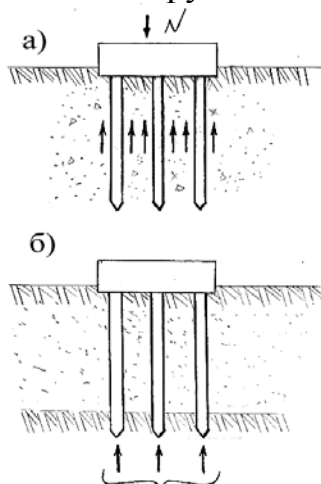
Сваи, отличающиеся по способу передачи нагрузки на грунт:
